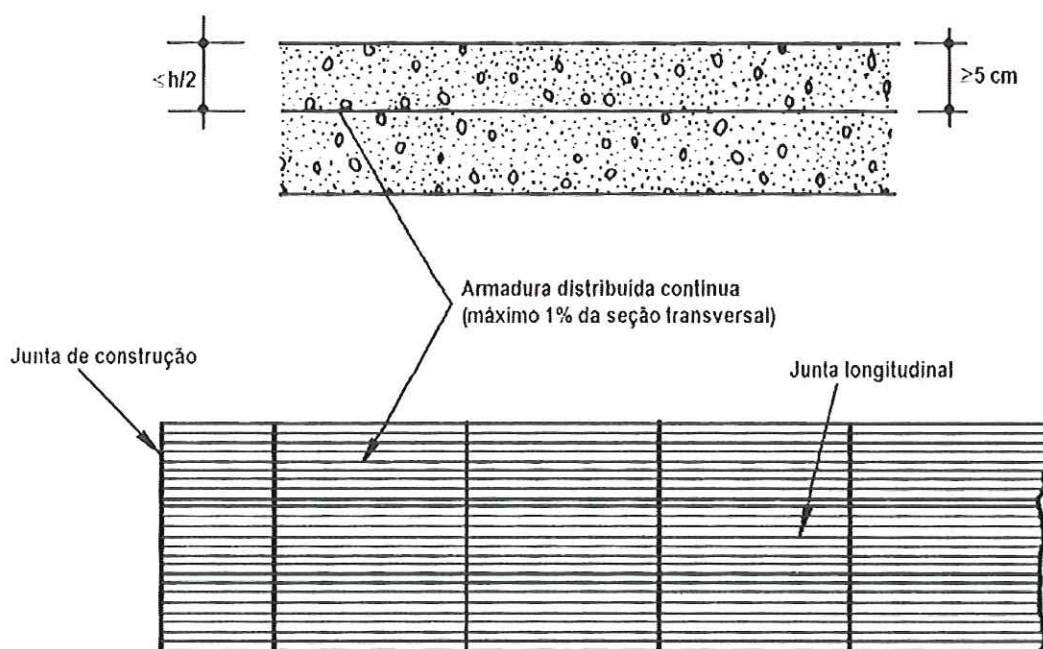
Pavimento de concreto com armadura contínua (Carvalho e Pitta, 1996)
